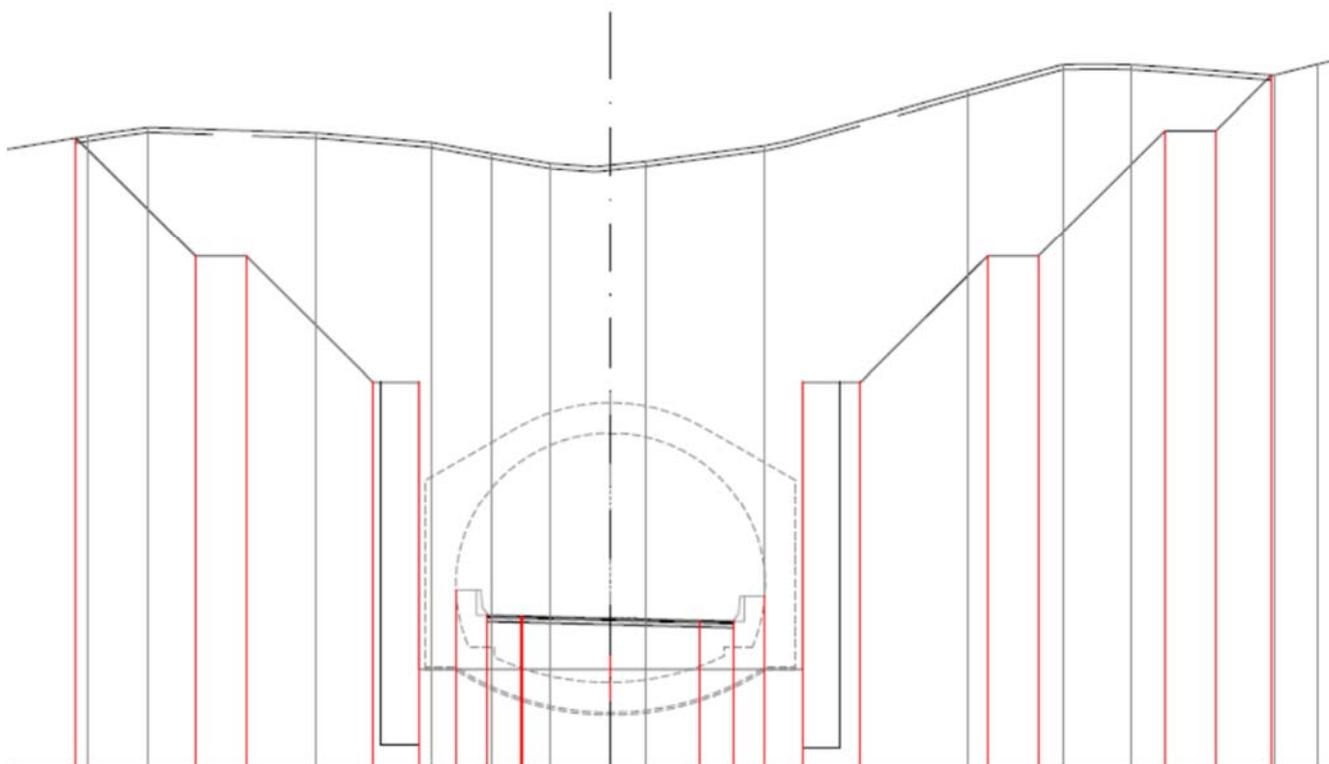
Sezione trasversale di scavo galleria Colle del Vento
